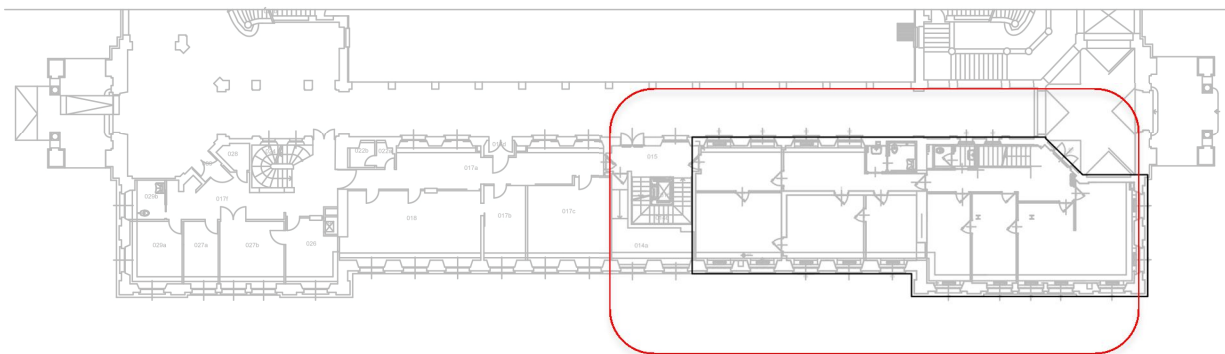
Ritaglio Pianta Piano Terra edificio 2 con segnalazione della zona interessata dal rilievo
